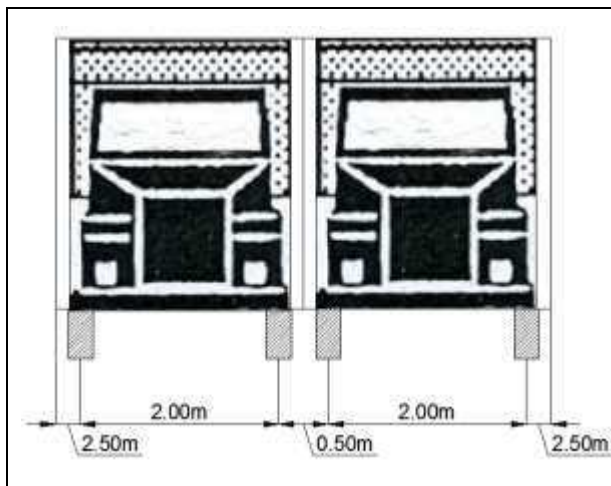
Coupe Transversale des camions du sous-systeme Bc
